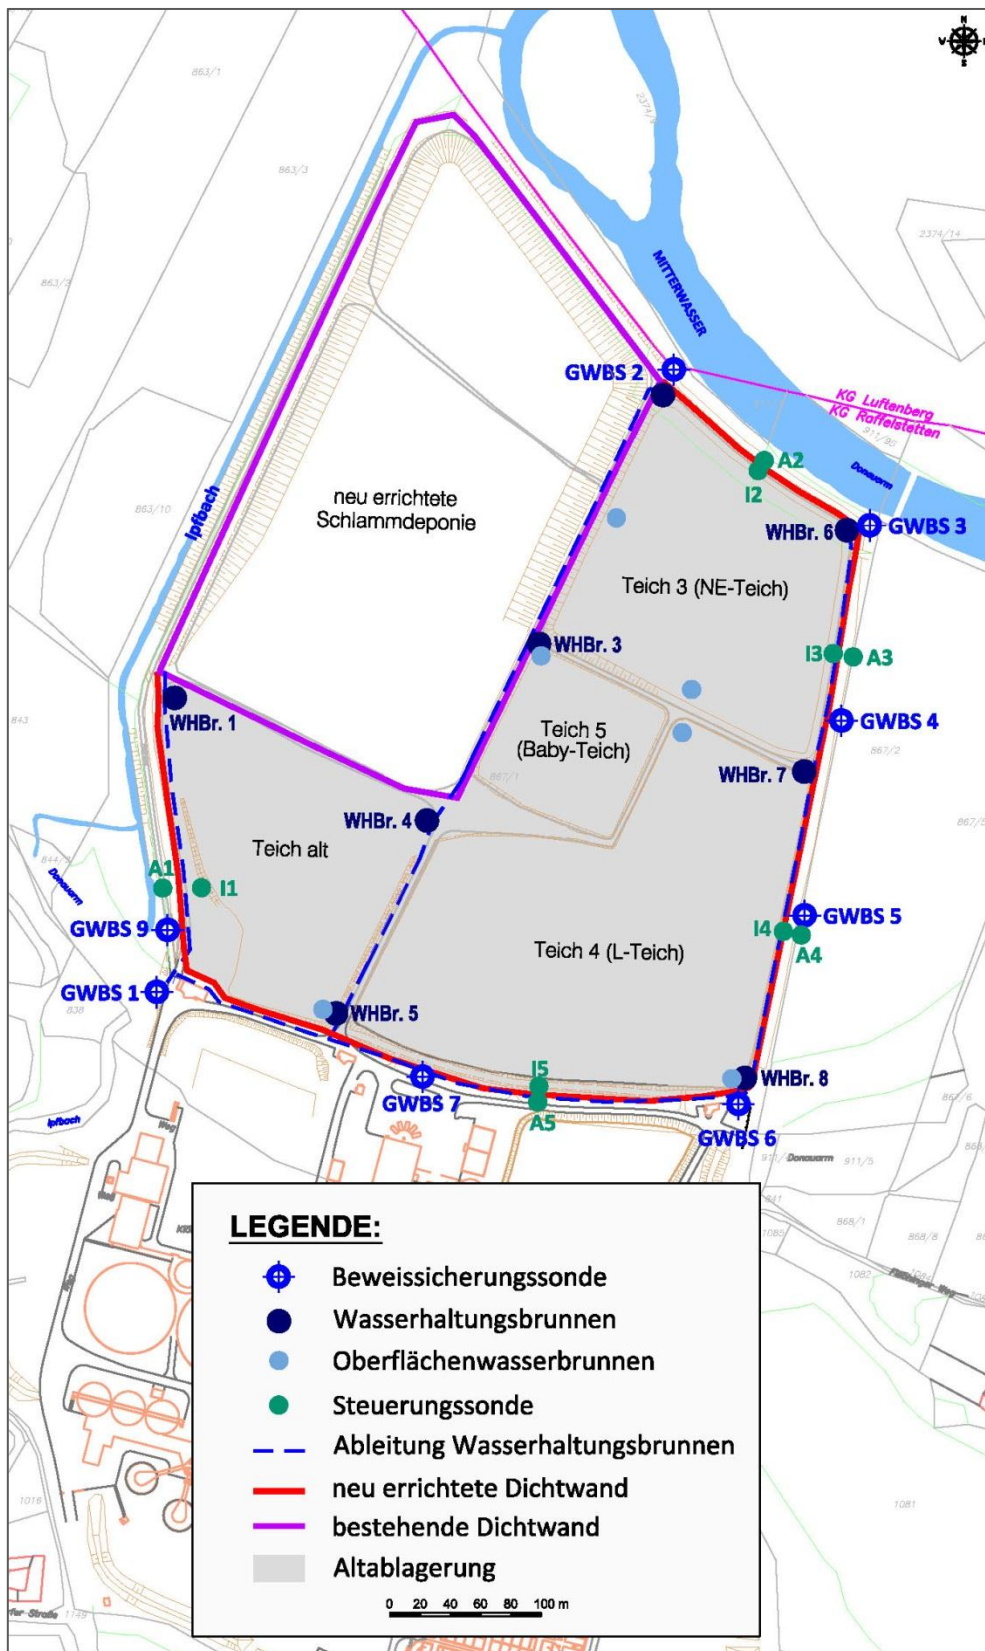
Klärschlammteiche RKA Asten“ – Übersichtlageplan der Sicherungsanlage (Brunnen, Sammelleitungen, Dichtwandssystem)
